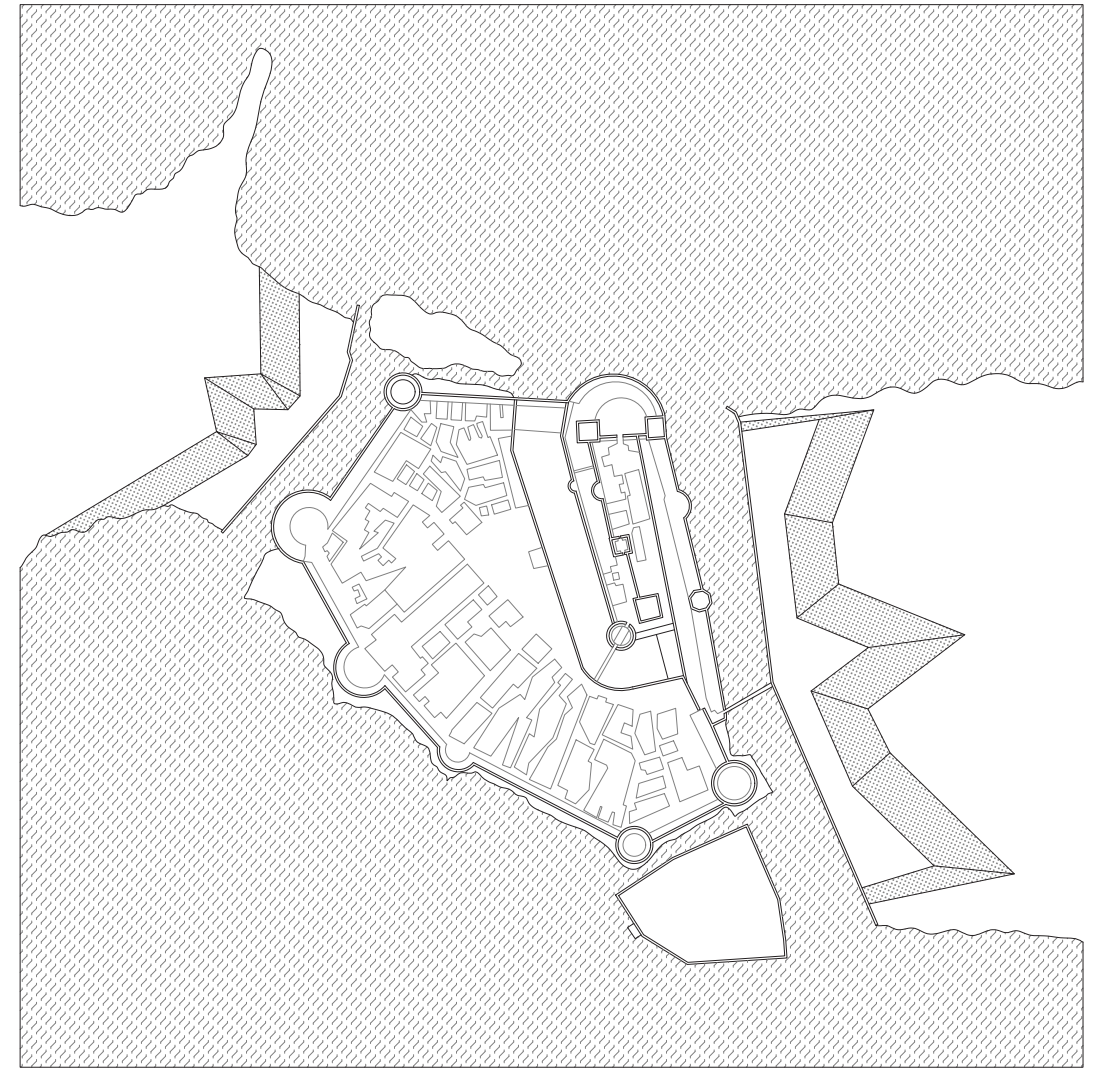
Ricostruzione della pianta interna della fortezza di S. Maura
